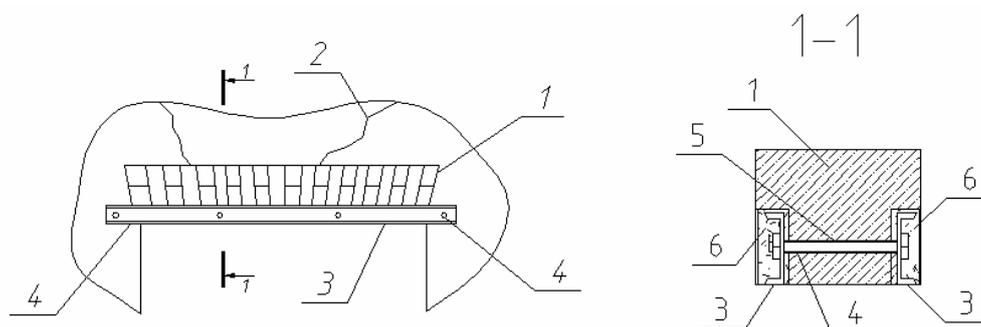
Усиление перемычек устройством разгружающих балок в штрабах: 1 – усиливаемая перемычка; 2 – трещины в перемычке; 3 – накладки из швеллера; 4 – стяжные болты, установленные в просверленные отверстия; 5 – отверстия в стене (после установки зачеканиваются раствором); 6 – штукатурка по сетке
